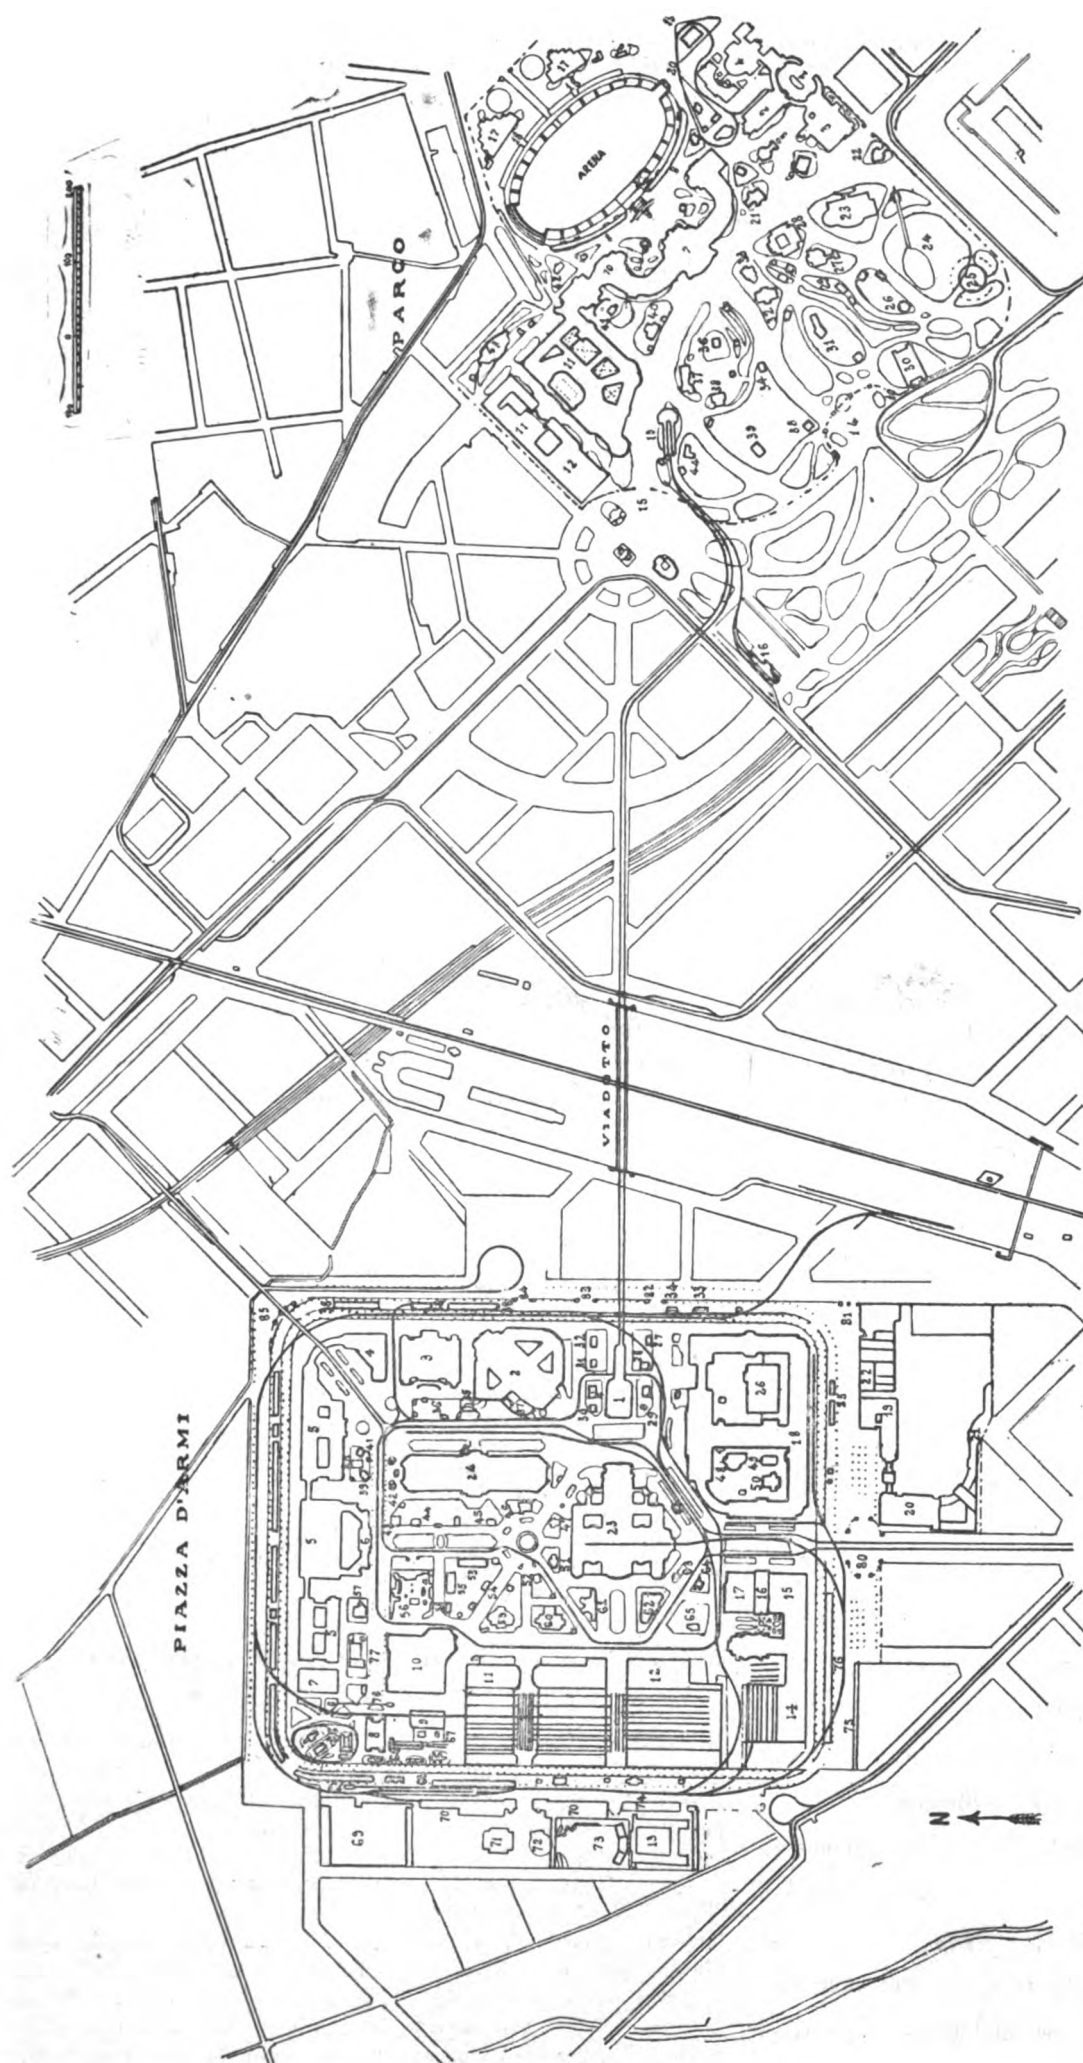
L'Esposizione di Milano. — Pianta generale degli edifici.
